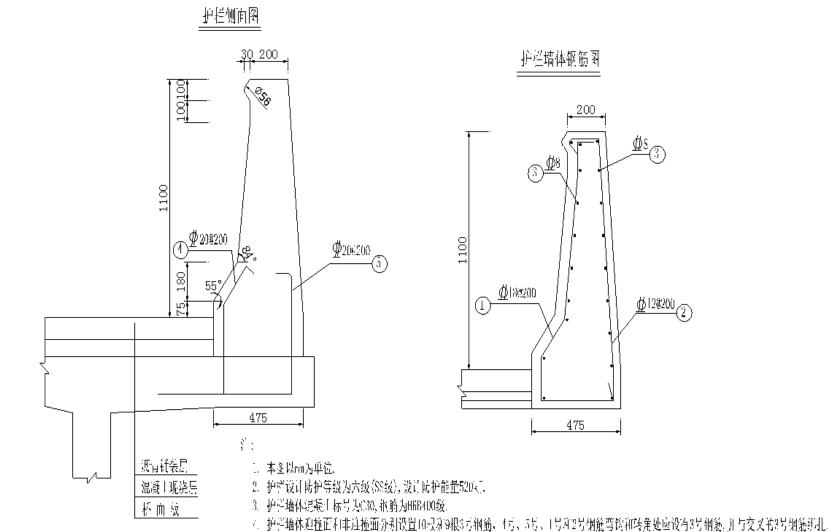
六 (SS) 级 F 型桥梁混凝土护栏设计示例 (尺寸单位: mm)
